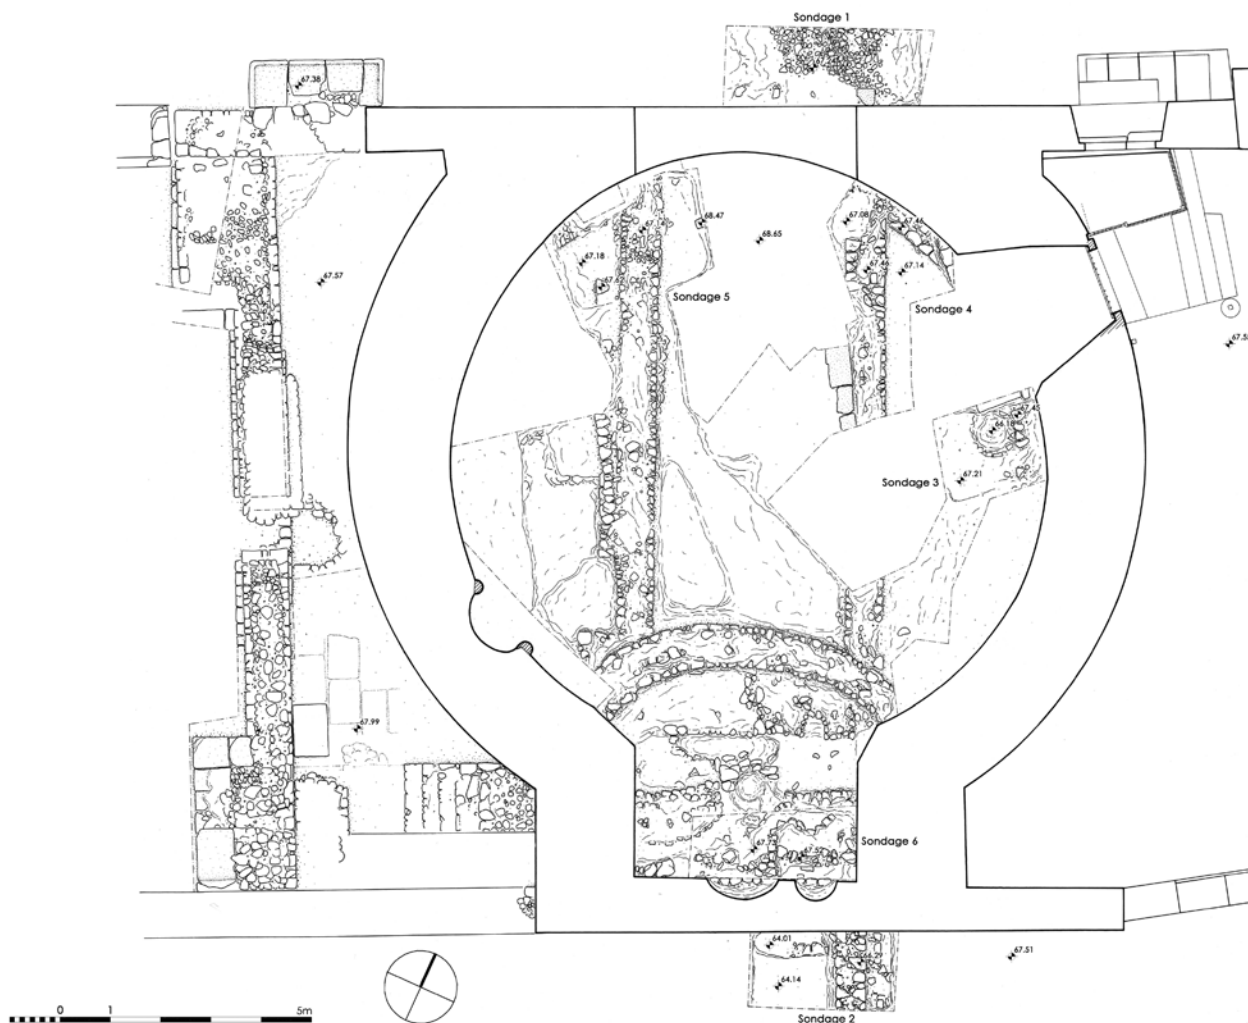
Pergamon, Rote Halle. Nördlicher Rundturm, Grundriss des Turms mit Eintragung der Sondagen und Grabungsbefunde im Inneren und Äußeren (M. 1 : 150)
